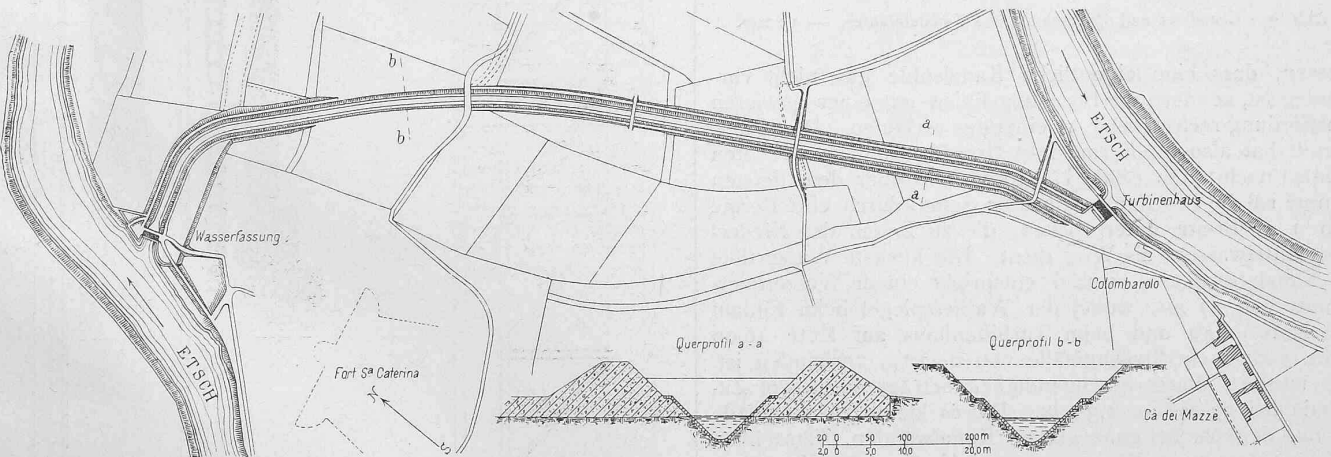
Lageplan der Anlage und Querprofile des Zulaufkanales. — Masstab 1:10000 für den Lageplan und 1:1000 für die Querprofile.
